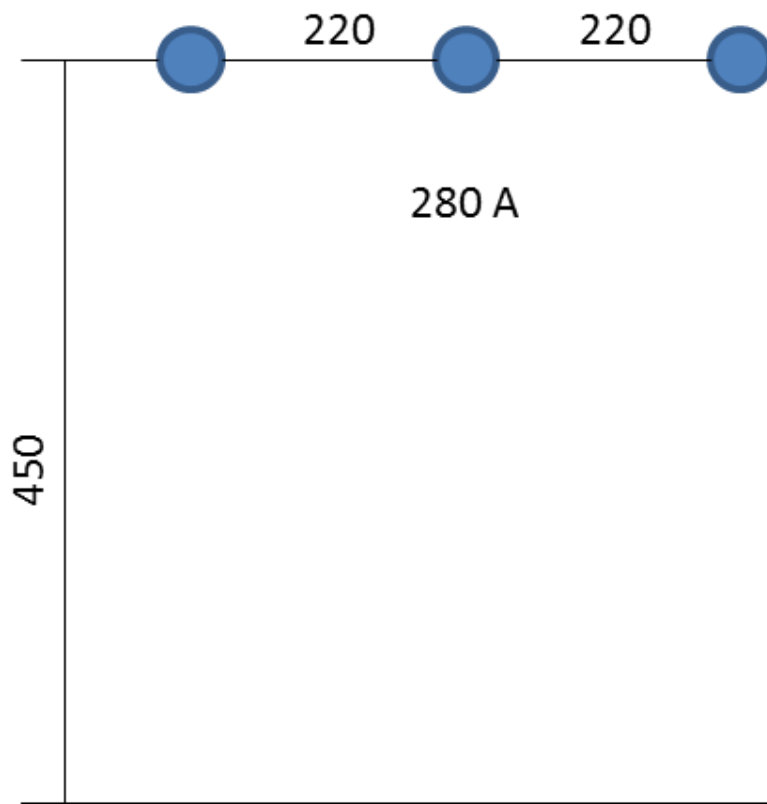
Sezione verticale della sbarra di collegamento tra la stazione elettrica utente e la cabina primaria di e-distribuzione (quote in cm)
